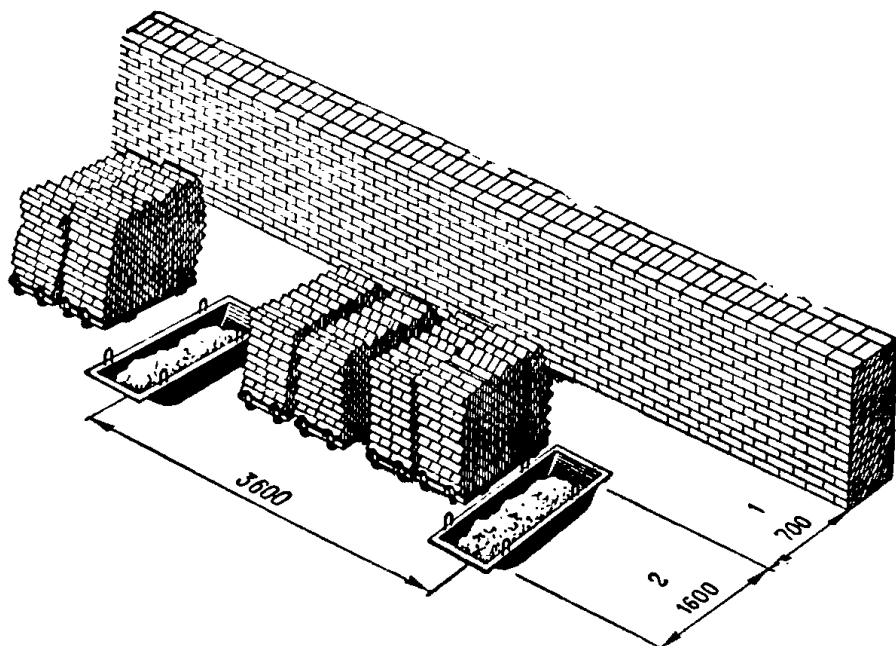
Схема размещения материалов на рабочем месте при кладке глухих стен
